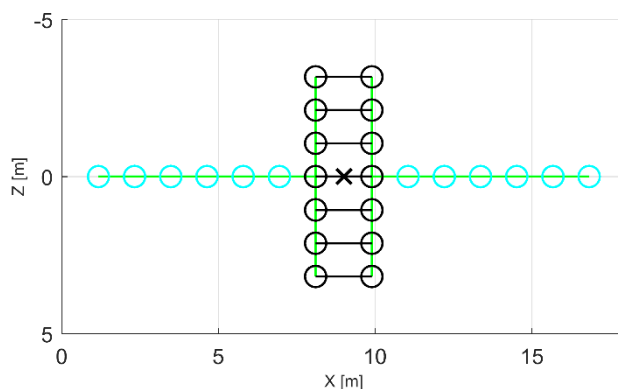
Vista en planta del modelo BTM, edificio con muros T. Ubicación nodo maestro y conexión entre muros.
